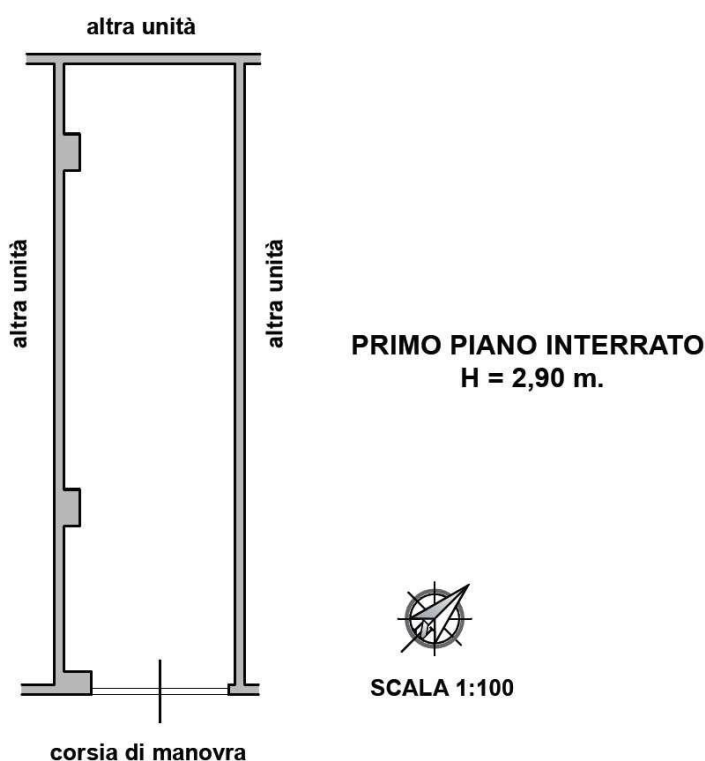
LOTTO 9 – Planimetria box auto foglio 76 – part. 620 – sub. 151
